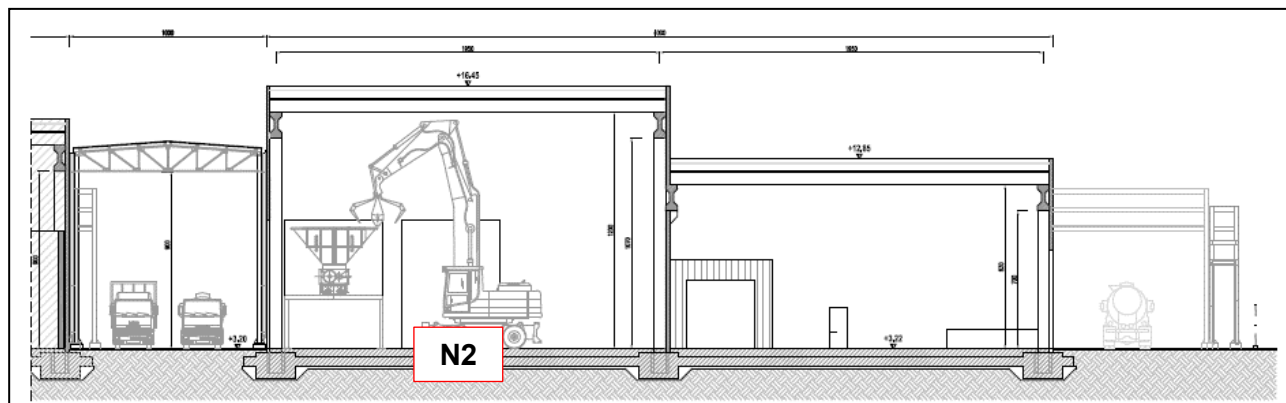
stralcio elaborato CO 05 RA VA 01 D1 PL 58.00 - N1- N2 PROSPETTI E SEZIONI
